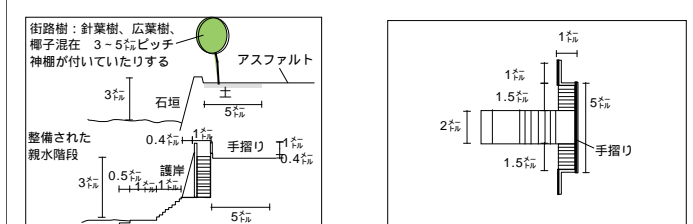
断面図（配置図NO.20） 図12 平面図（配置図NO.20）
